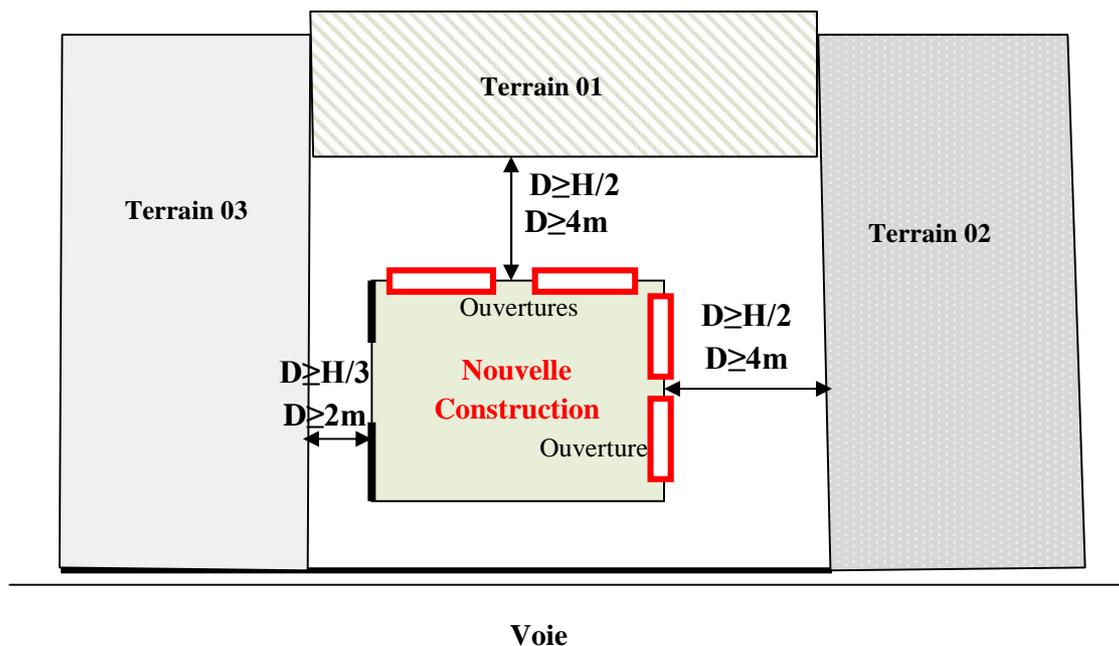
Vue en Plan définissant les règles d'implantation d'une construction par rapport aux limites séparatives
